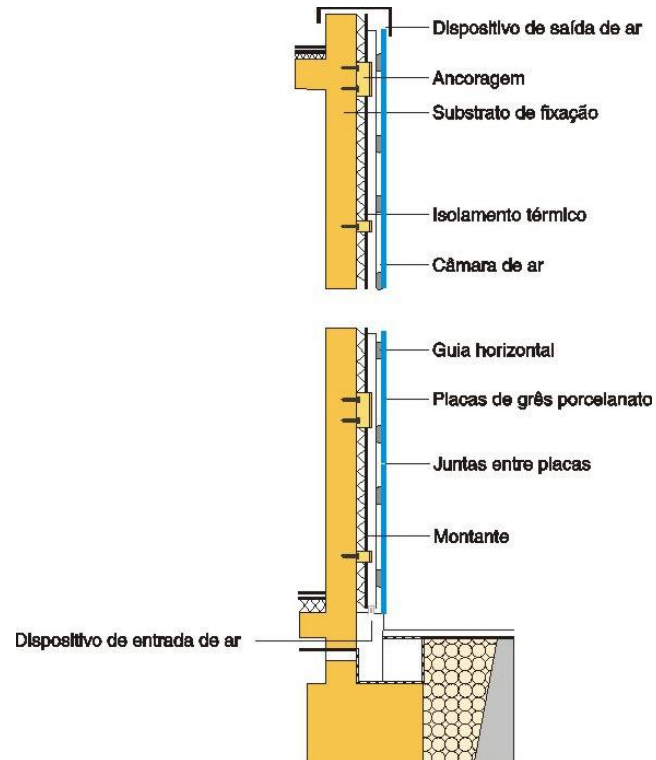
Corte transversal indicando os componentes da fachada ventilada
